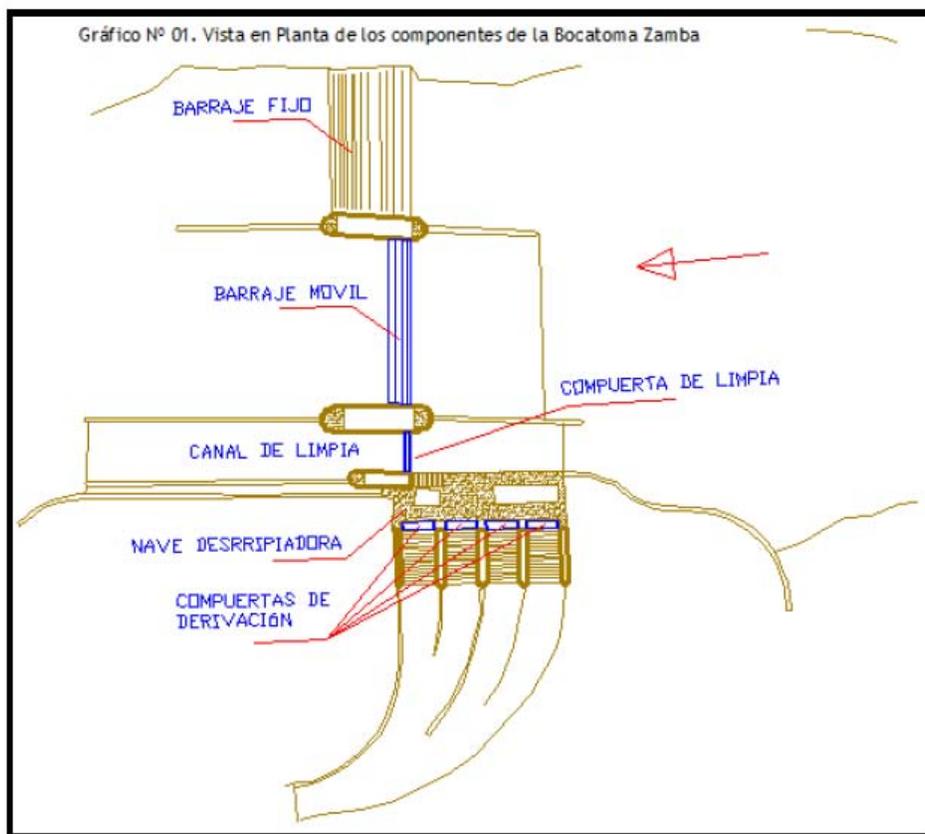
Vista en Planta de los componentes de la Bocatoma Zamba
